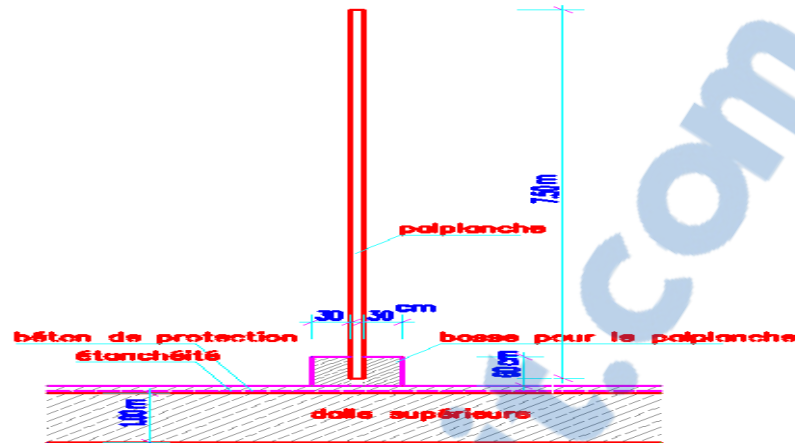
Palplanches sur la dalle en béton. (Omrani K et Boutria H, 2012)
